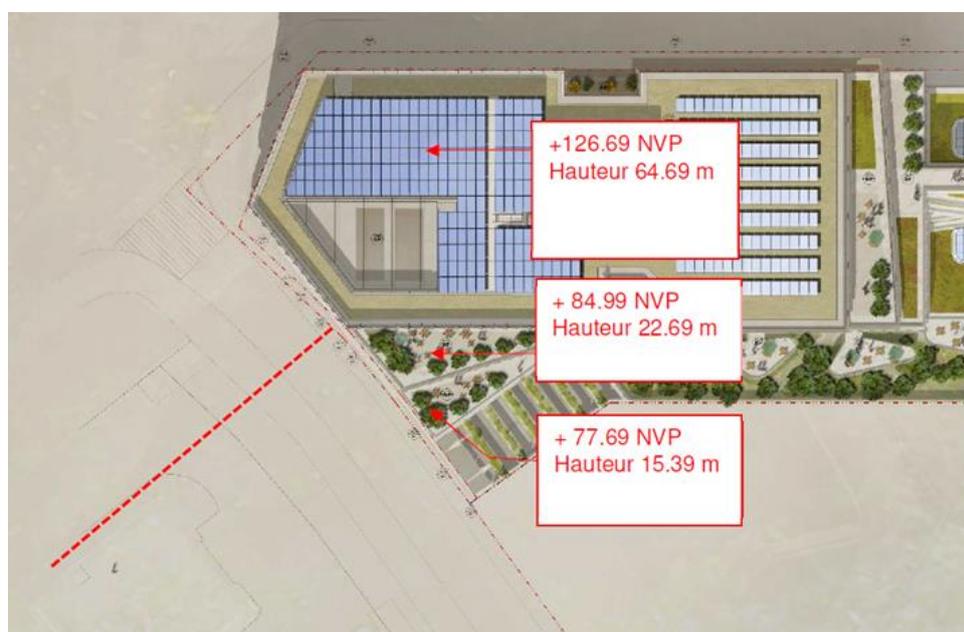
Hauteur des différentes toitures faisant donnant sur l'avenue Larousse
